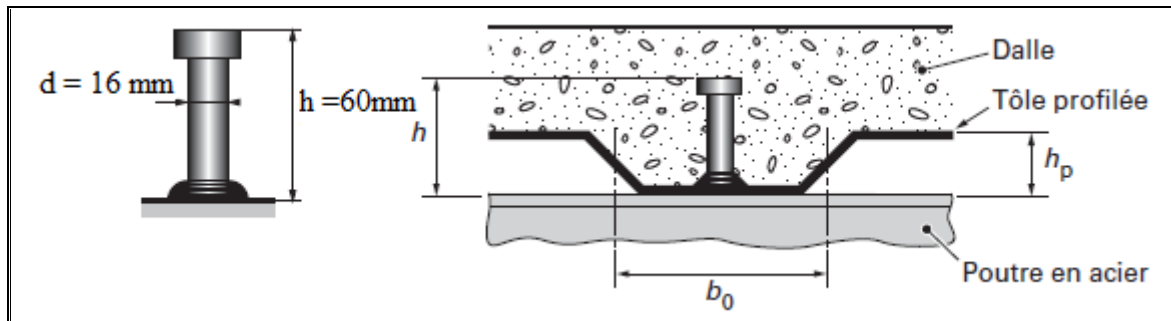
Goujon à tête soudée avec dalle mixte.
